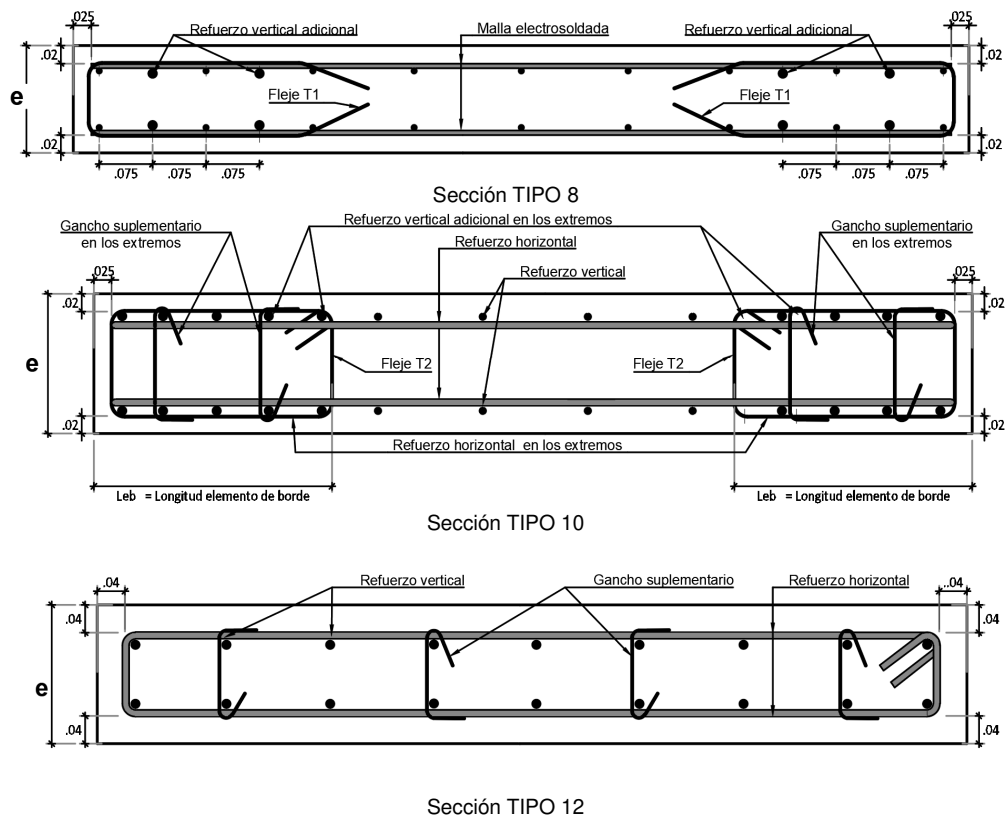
Secciones de refuerzo tipo para muros (cortesía de P&P Proyectos S.A.S)
